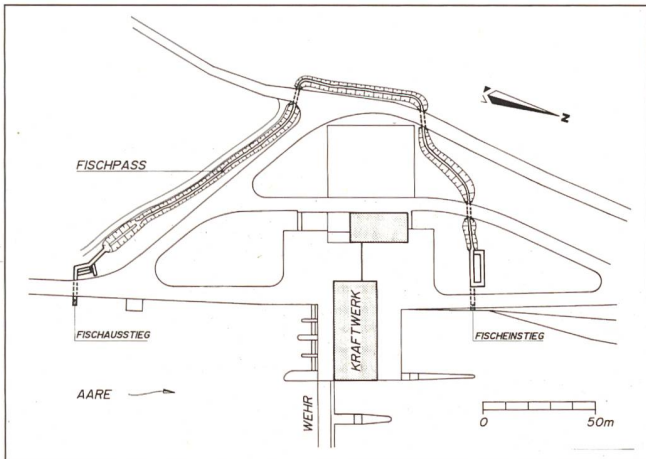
Kraftwerk Aarberg mit Fischpass (Lageplan).
